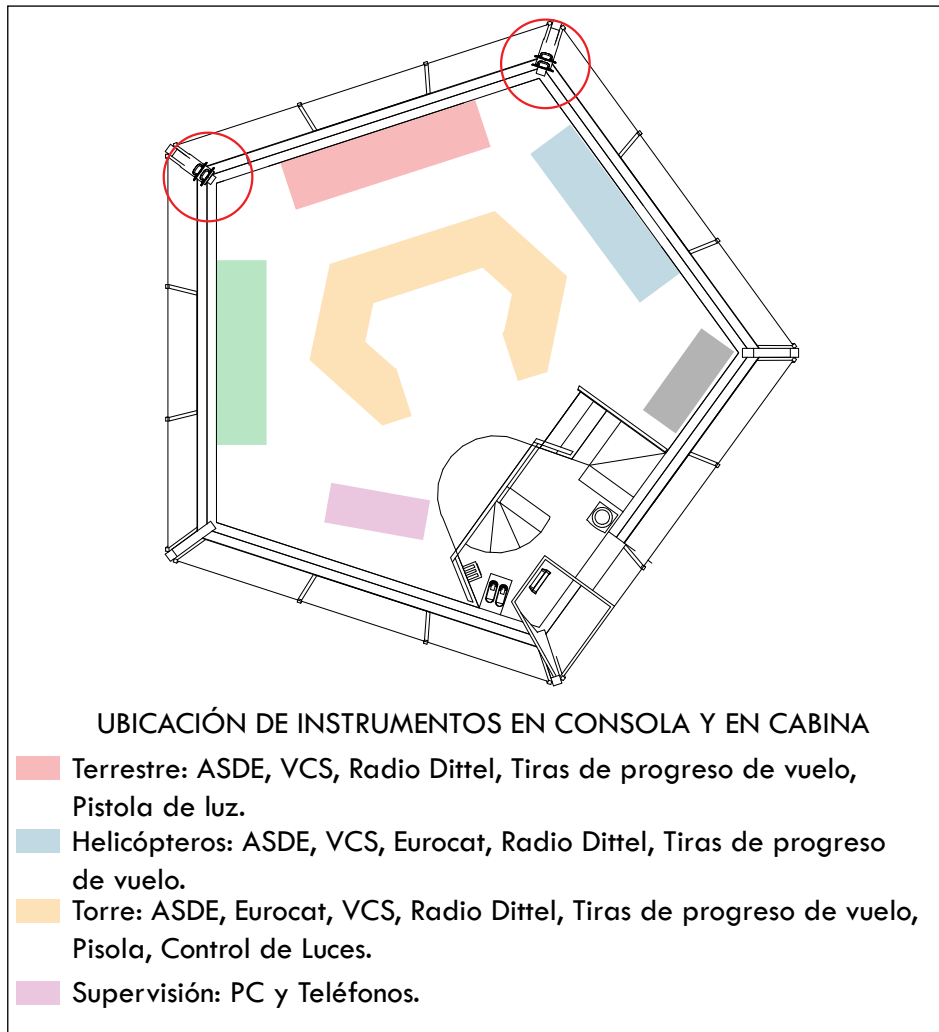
Planta de distribución de Instrumentos en la Cabina de la TCTA del AICM.
